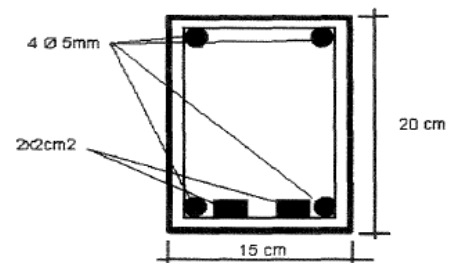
Posicionamento de armadura na viga 1 ensaiada
